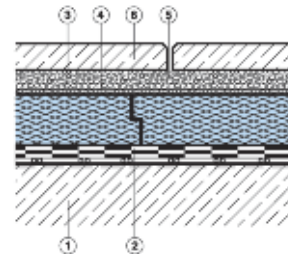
1 – основание кровли, ж/б плита; 2 – гидроизоляция; 3 – утеплитель STYROFOAM 300A; 4 – геотекстиль; 5 – мелкий гравий 4/8 мм; 6 – тротуарная плитка
